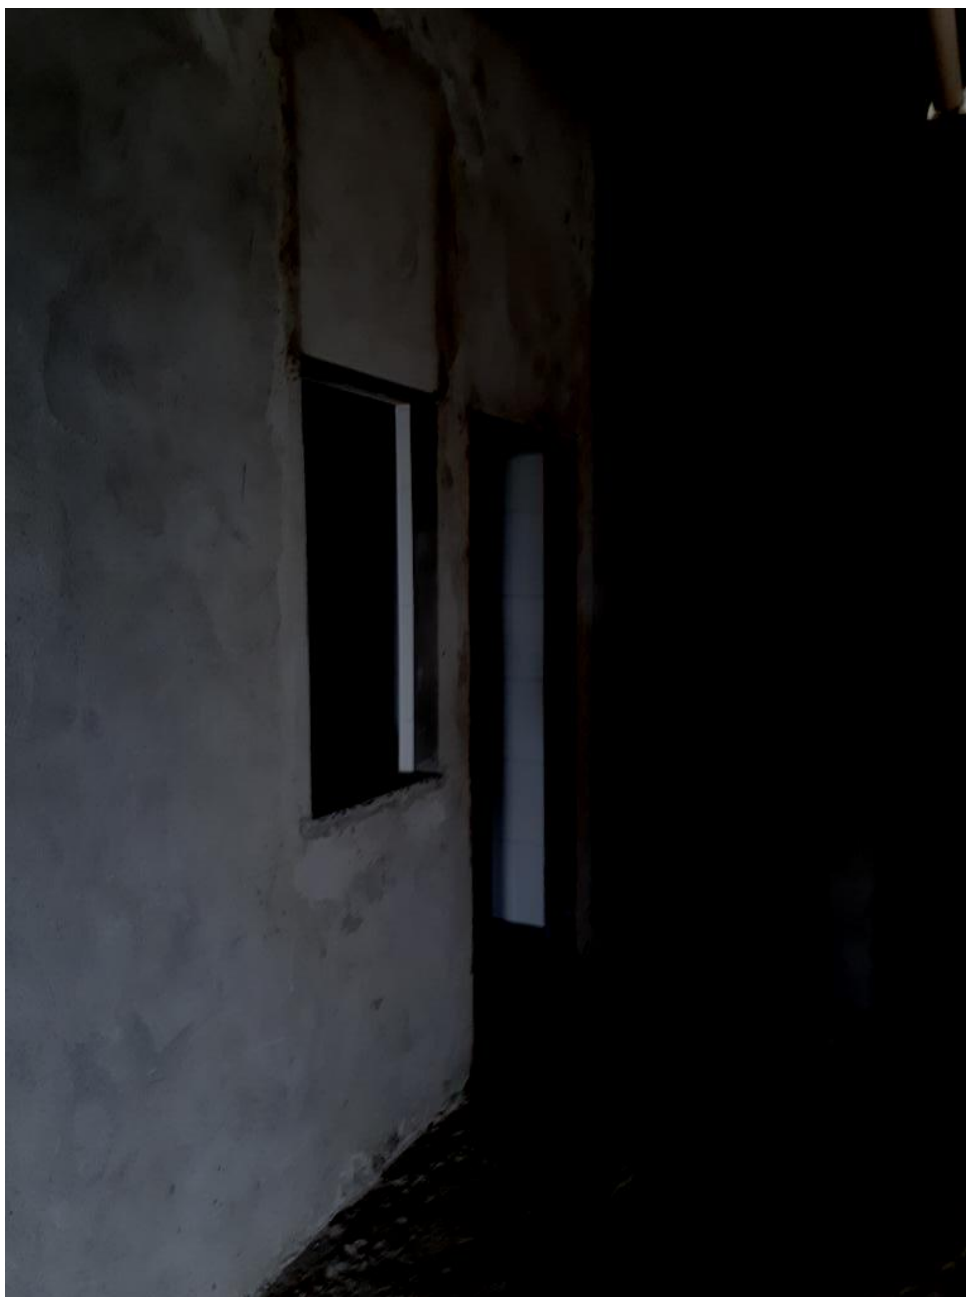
Vista Geral do primeiro andar. Alvenarias marcadas e levantadas. Detalhe da escada de ligação entre os acervos.
